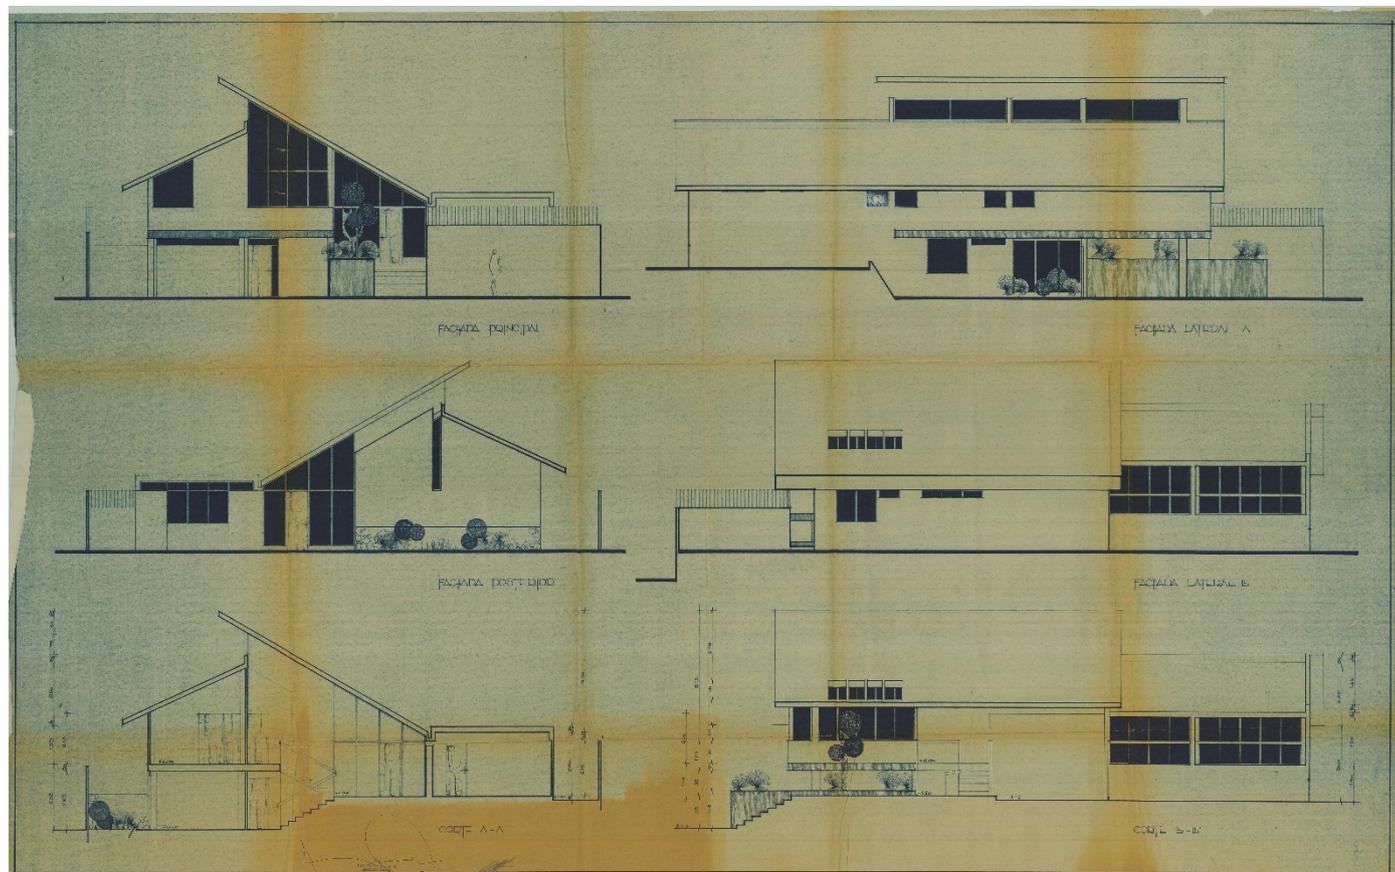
Planos originales de casa Moncayo, año 1974. Archivo René Bravo Rubira
